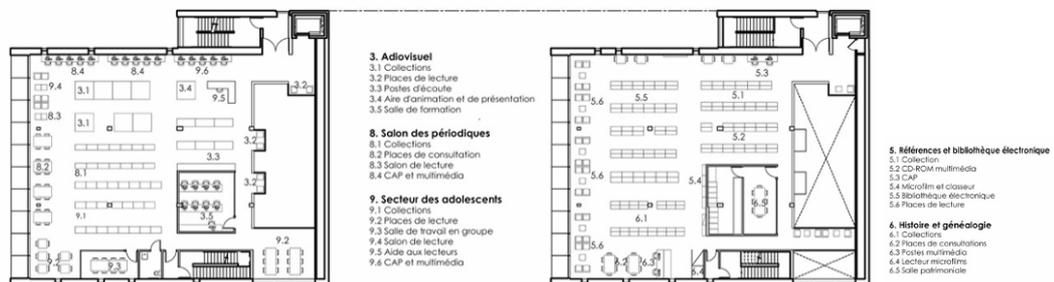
Planta baixa térreo e primeiro pavimento (Concurso de Projeto, 2010)
